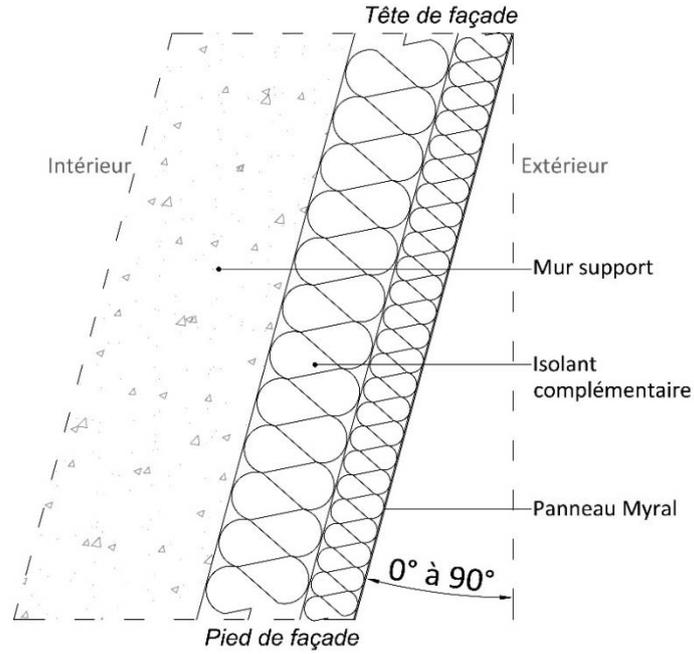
Pose des panneaux MYRAL en sous face (coupe verticale)
